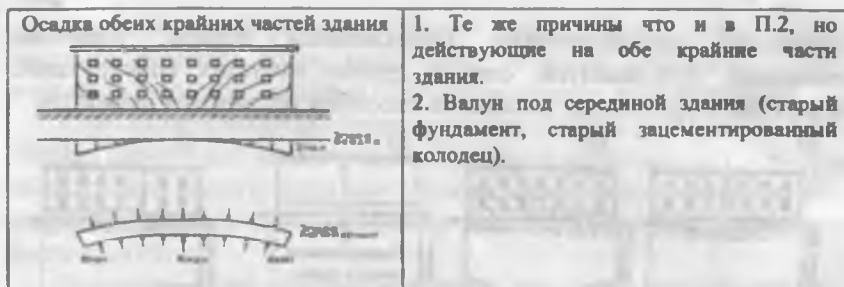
Вид трещины в каменных стенах зданий при основных видах осадки грунта оснований:
